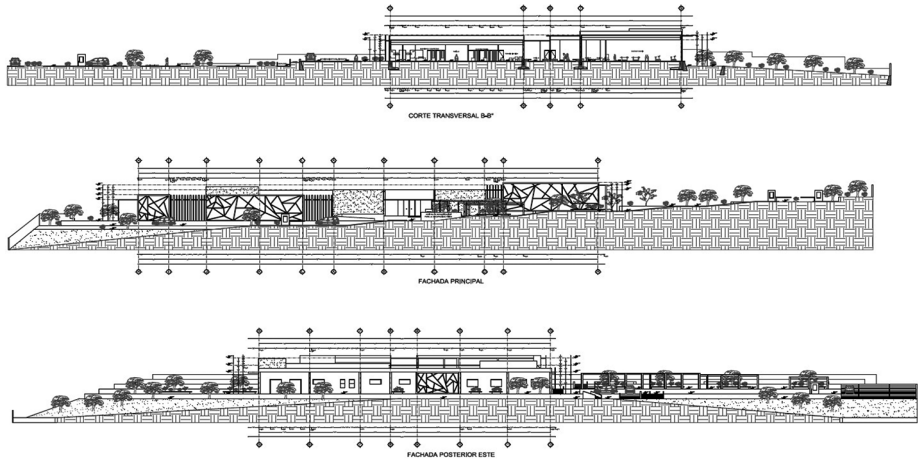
Arellano y Mendoza, corte y fachada del proyecto, renders, 2021.
